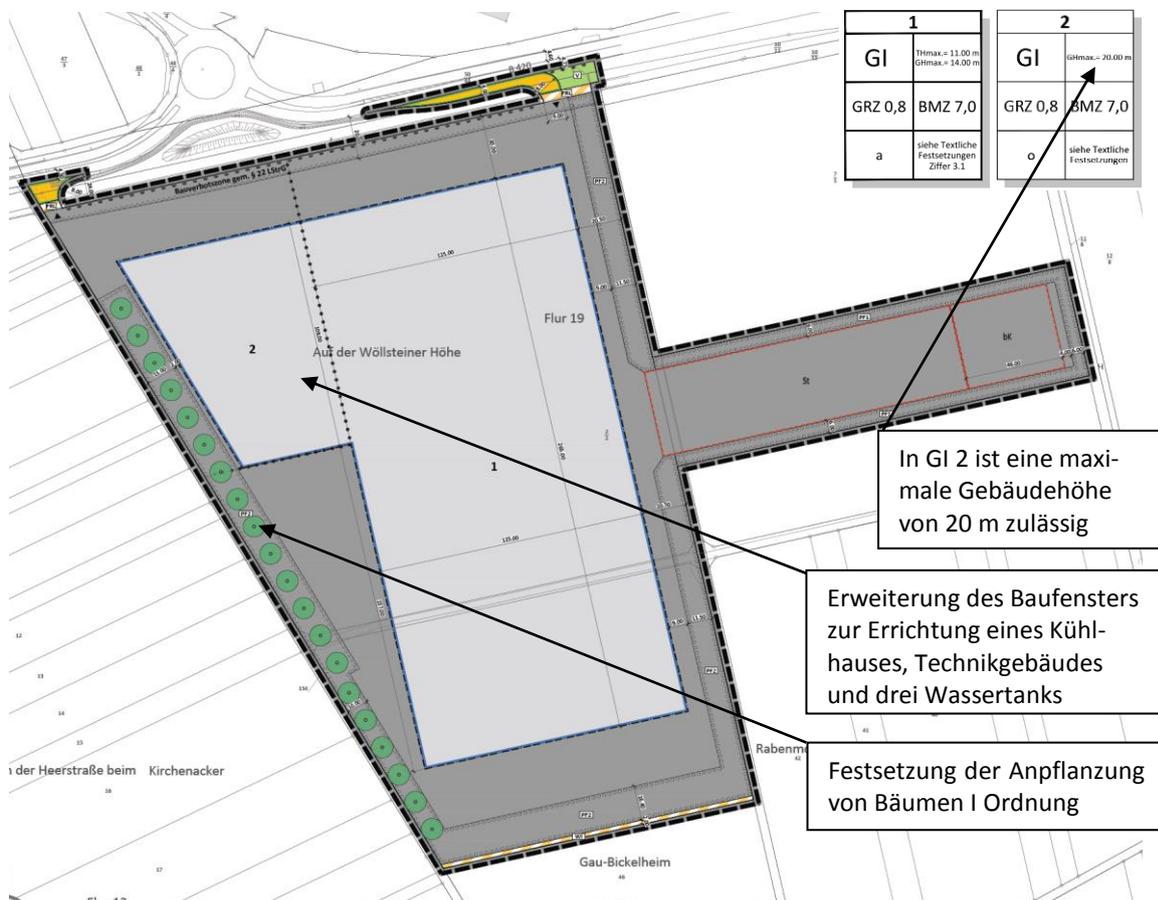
Bebauungsplan „Auf der Wöllsteiner Höhe II, 1. Änderung“
